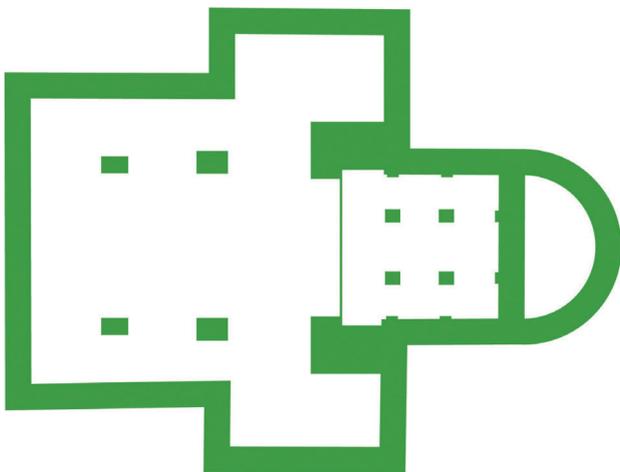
Ohrdruf Schloss Ehrenstein, Grundriss der Peterskirche um 980
